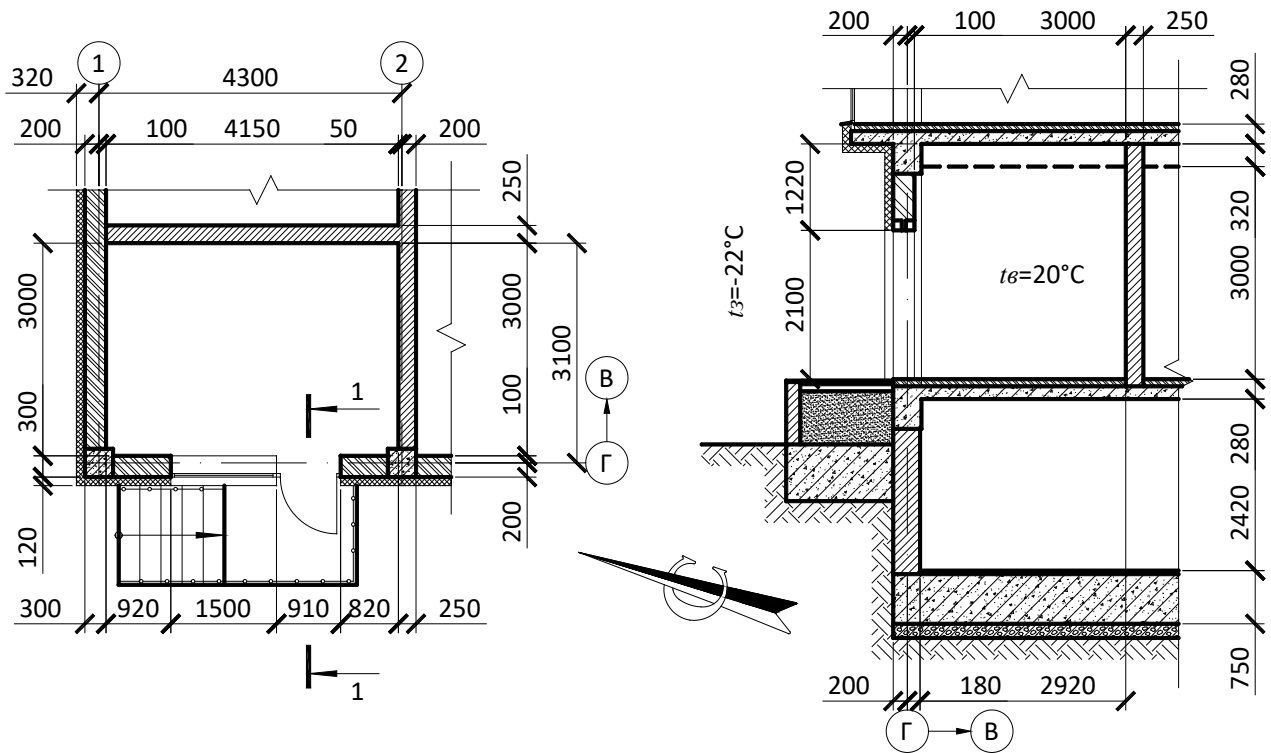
Фрагмент плану першого поверху та переріз.
